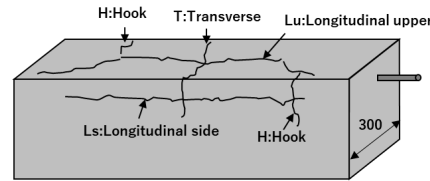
試験体名末尾にtを付していない試験体のひび割れ種類
